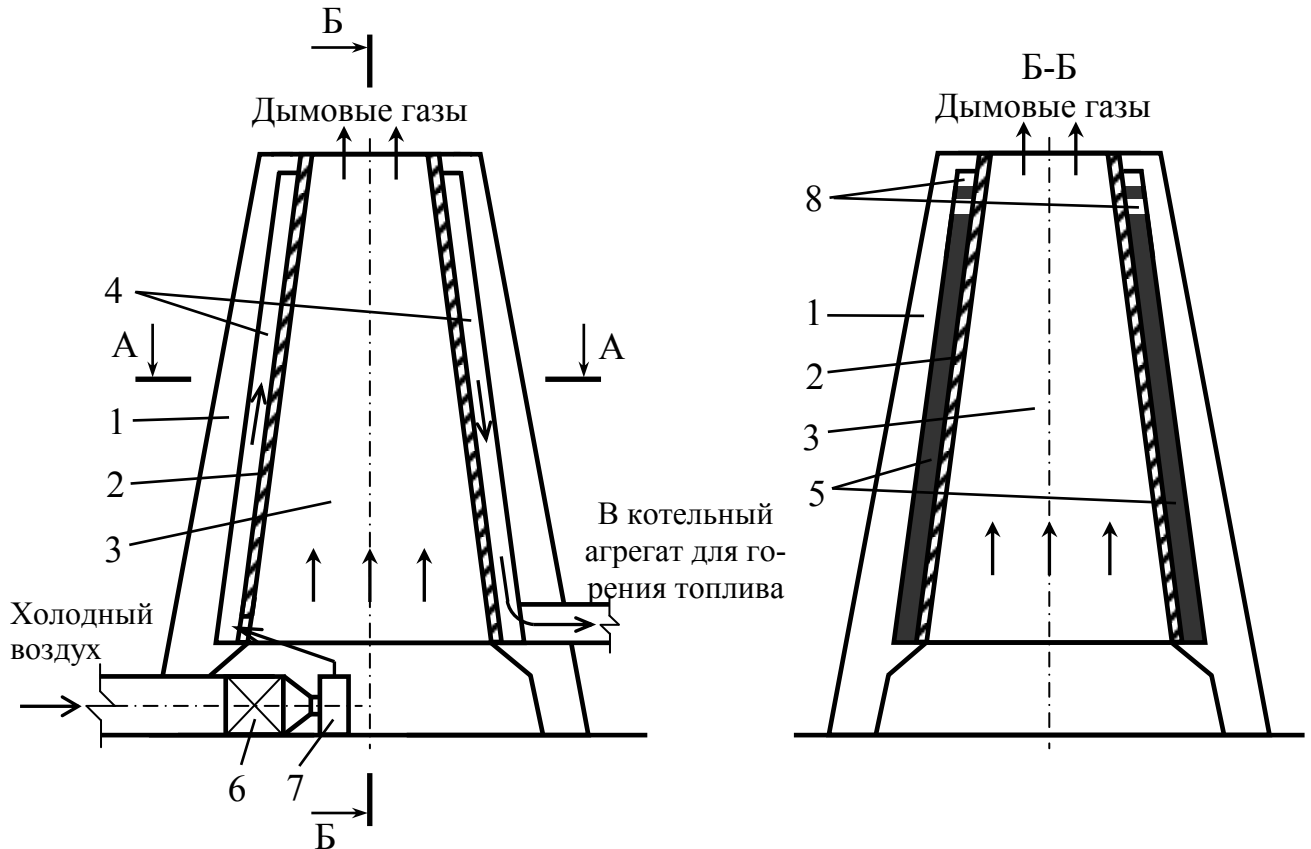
Конструкция дымовой трубы с воздушным каналом: 1 – железобетонный ствол; 2 – футеровка; 3 – газоотводящий канал; 4 – воздушный канал; 5 – вертикальные перегородки; 6 – калорифер; 7 – вентилятор; 8 – отверстия в вертикальных перегородках; сечение А-А – то же, что и на рис. 7.1
